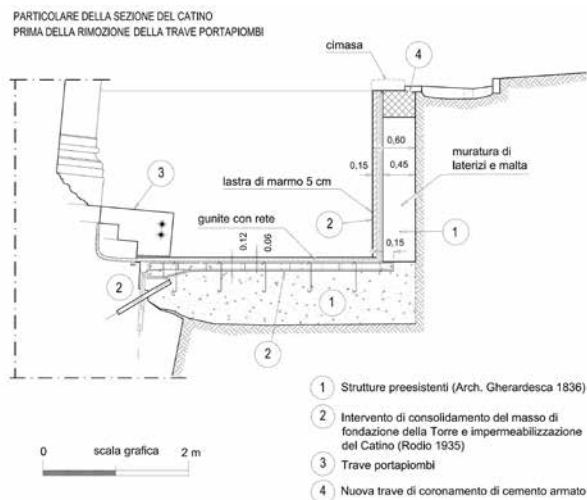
Lavori di stabilizzazione della Torre di Pisa. Particolare della sezione del Catino dal lato sud prima della rimozione della trave porta-piombi.
